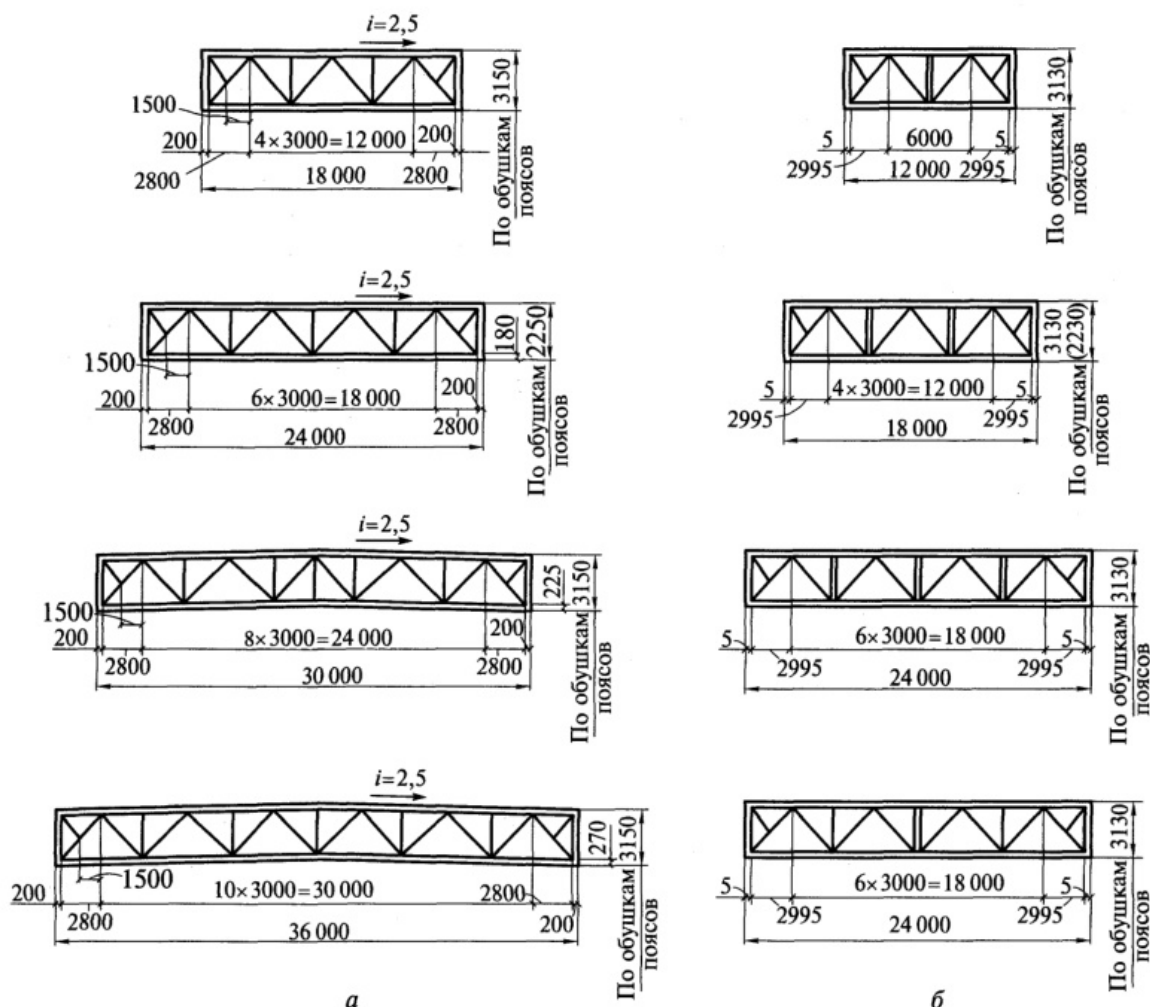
Типовые схемы стропильных (а) и подстропильных (б) ферм для покрытия с уклоном кровли 2,5 %
